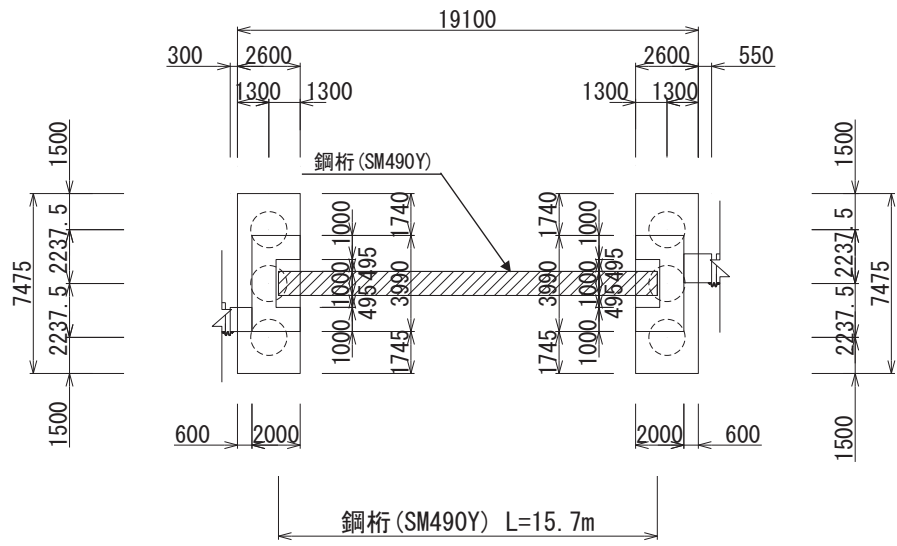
(2) 鋼製遮水壁 (鋼桁 3) 平面図
